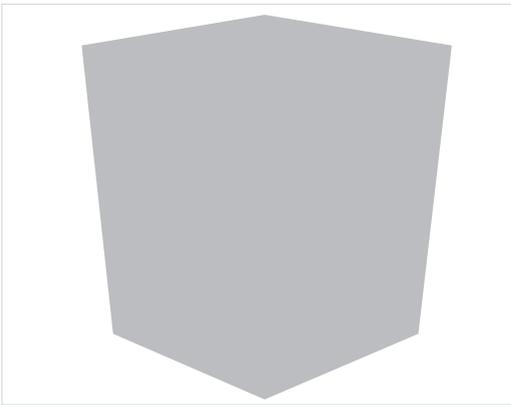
Pilar metálico Nivel de desarrollo 100. Fuente: BIM Forum 2013, B 1010.10\_Floor Structural Frame\_Steel Framing Columns
